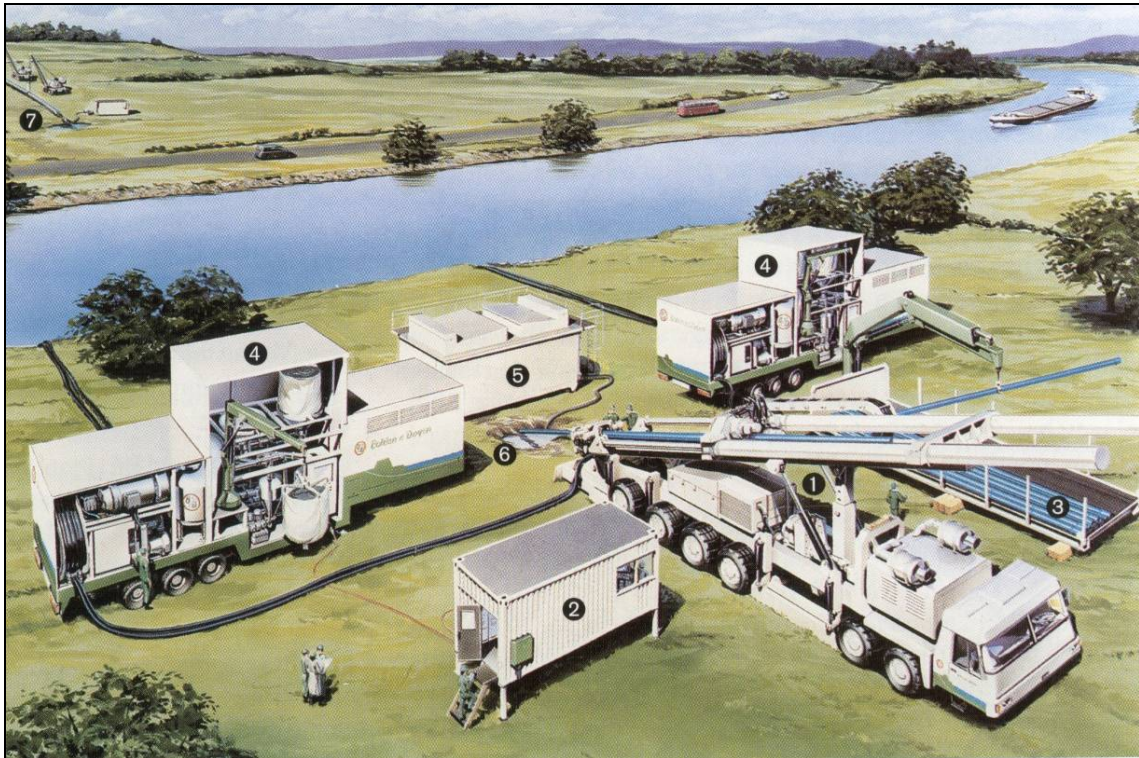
Prinzipieller Baustellenaufbau beim HDD-Verfahren [1-4].
